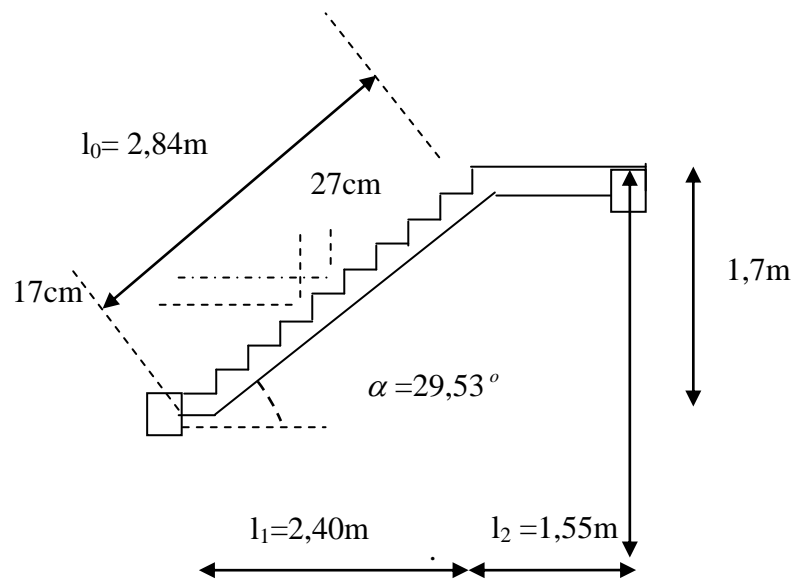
Coupe verticale de la paillasse d'étage courant.
